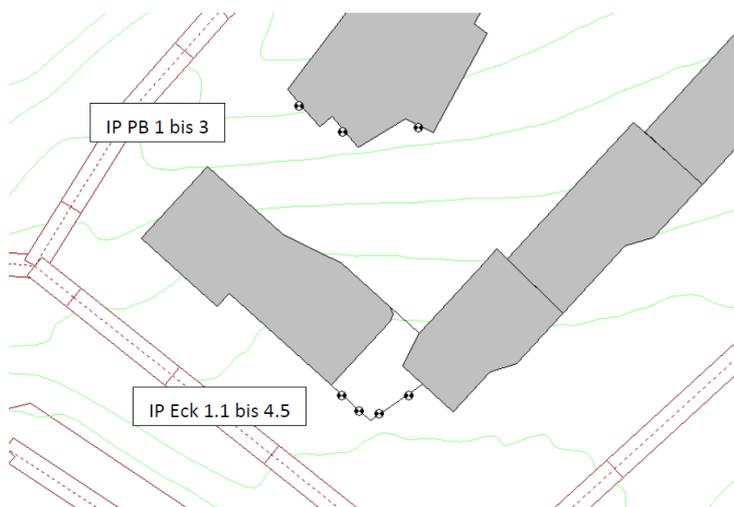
Modellierung der Eckbaute als schwebende Schirme, Erfassung der Fassadenbelastung mit Immissionspunkten, Darstellung im Grundriss.
